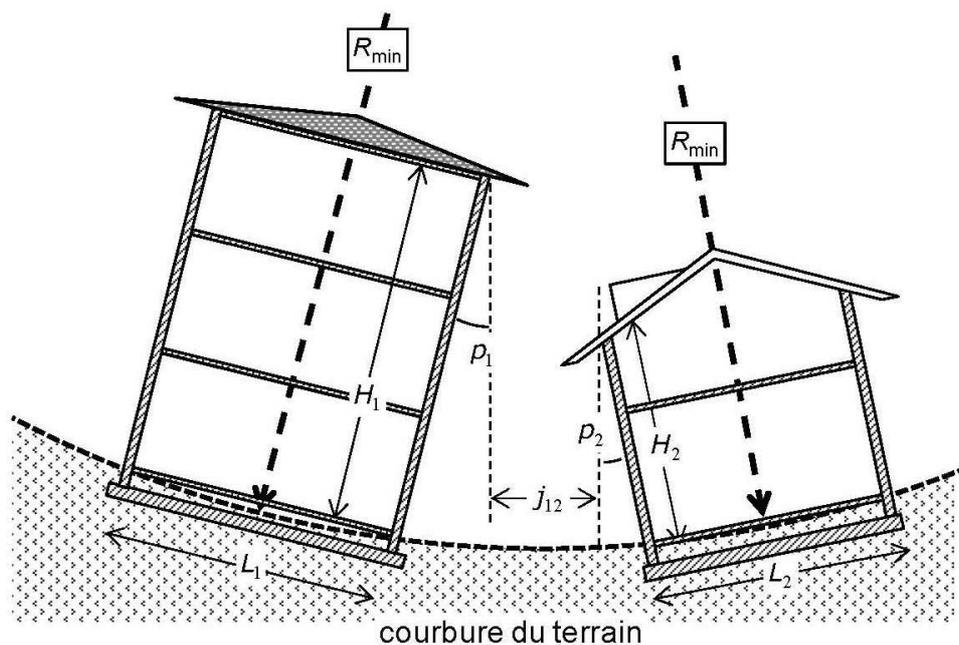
Largeur du joint vertical d'affaissement due à la courbure du terrain
